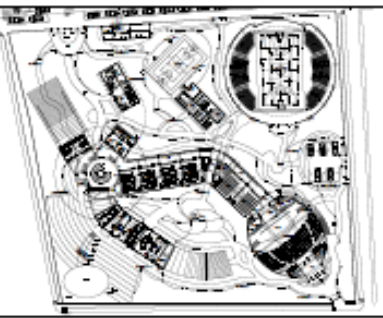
Plano de Diseño de Instalaciones Básicas Bloque 01 – Eléctricas - Plano N° 33 - Lamina IE-02
